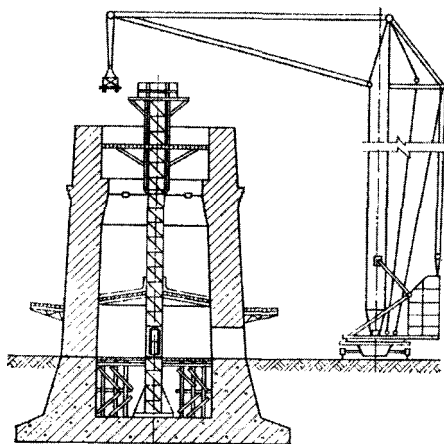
Организация вертикального транспорта материалов башенным краном при строительстве труб с толстыми стенами
